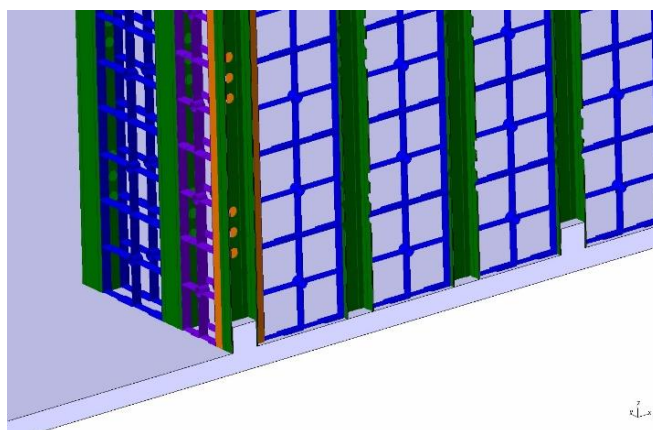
Representação em corte da estrutura realçando a fixação da estrutura à laje.
